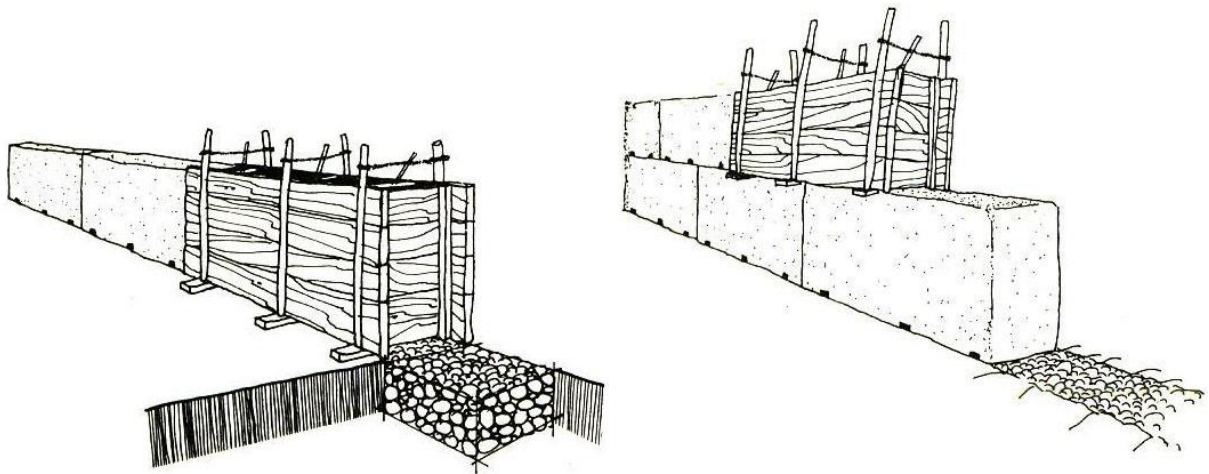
| Técnica da construção | Fonte: www.coisasdaarquitectura.files.wordpress.com
